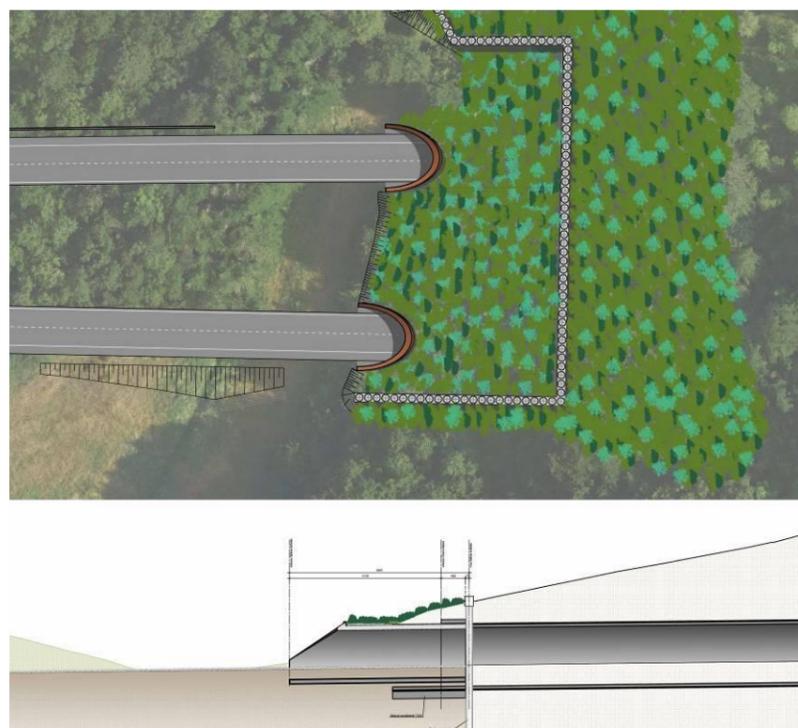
Planimetria e prospetto galleria Citerna (imbocco ovest)
